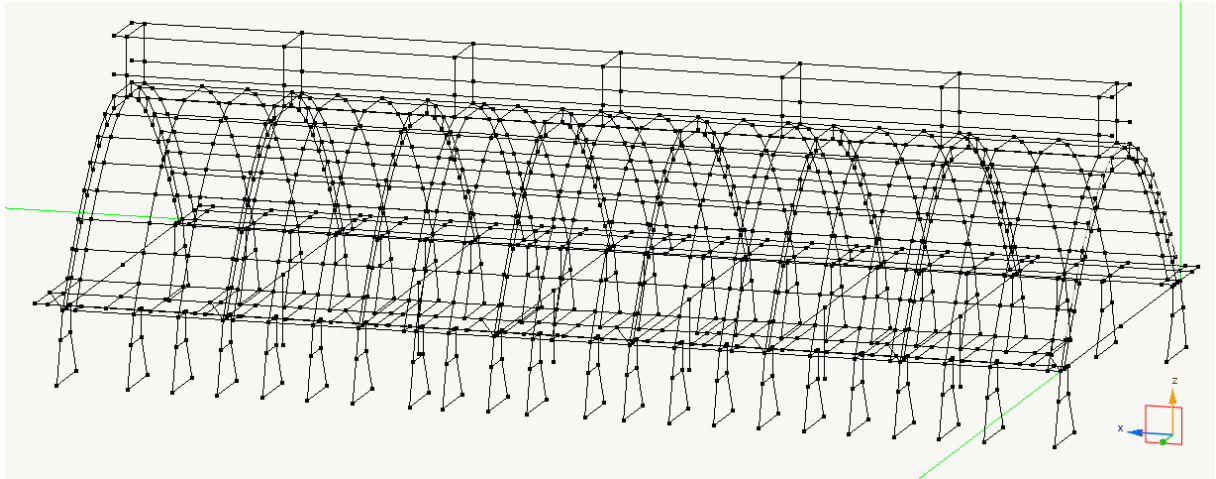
Definizione della sezione delle travi secondarie.
